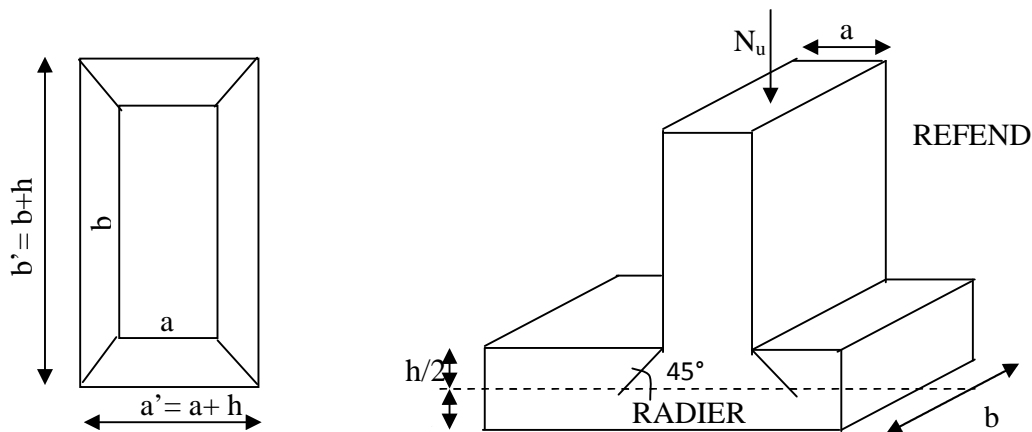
Périmètre utile des voiles et des poteaux.
